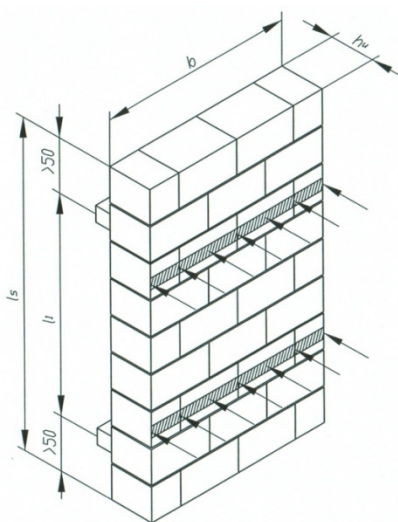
Схема испытания кладки при изгибе по неперевязанному сечению
